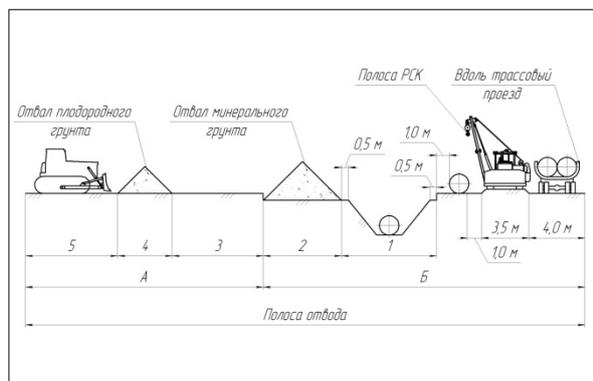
Поперечный профиль полосы, отведенной под строительство трубопровода
